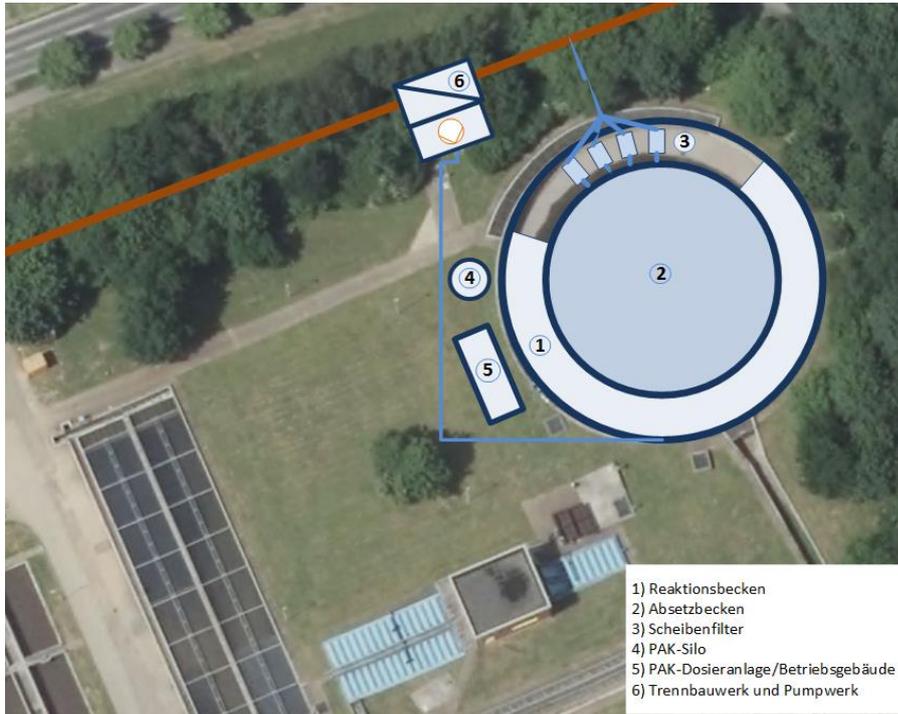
Lageplan der Variante 3, PAK-Anlage im alten Störfallbecken
